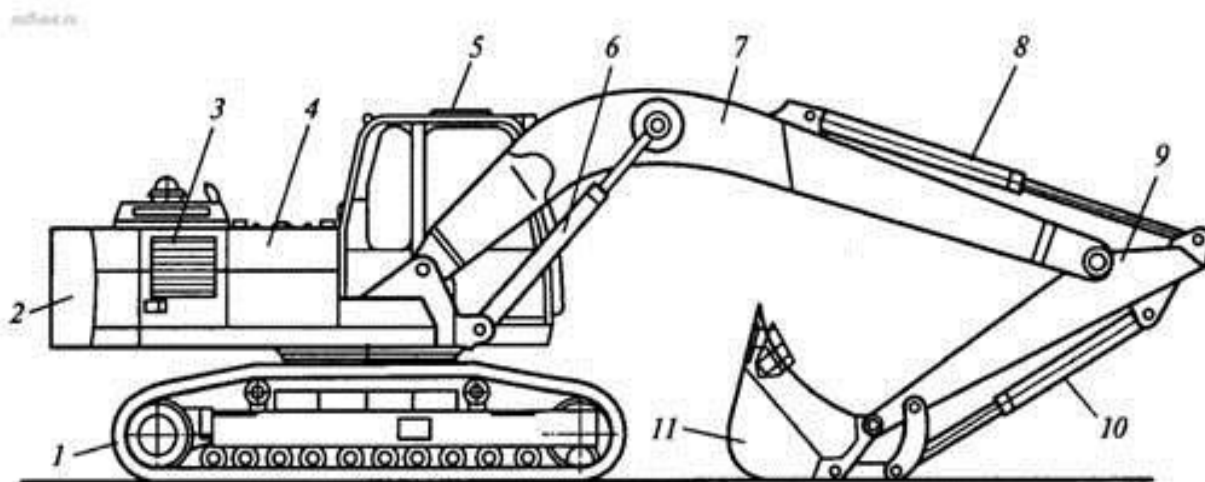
Экскаватор ЕТ-18 вид сбоку: 1 - гусеничное ходовое устройство; 2 - противовес; 3 - силовая установка; 4 - поворотная платформа; 5 - кабина оператора; 6, 8, 10 - гидроцилиндры стрелы, рукояти и ковша; 7 - стрела; 9 - рукоять; 11 – ковш.
